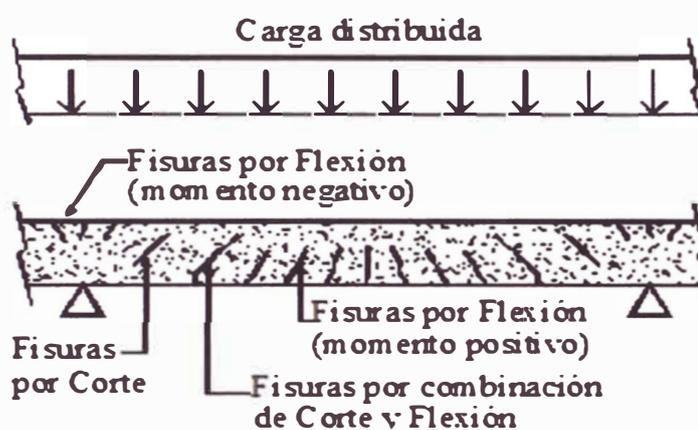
Fisuras por alargamiento de la armadura debido a la flexión excesiva.
